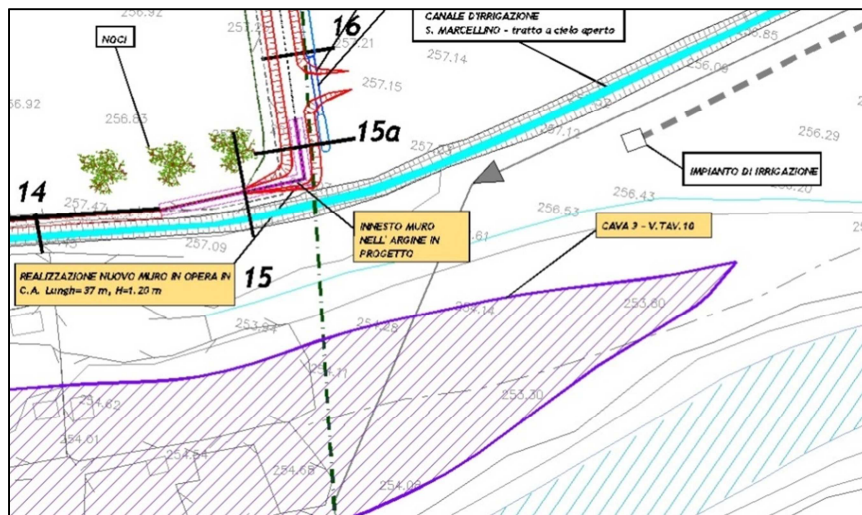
DETTAGLIO DELLA PLANIMETRIA DI PROGETTO
